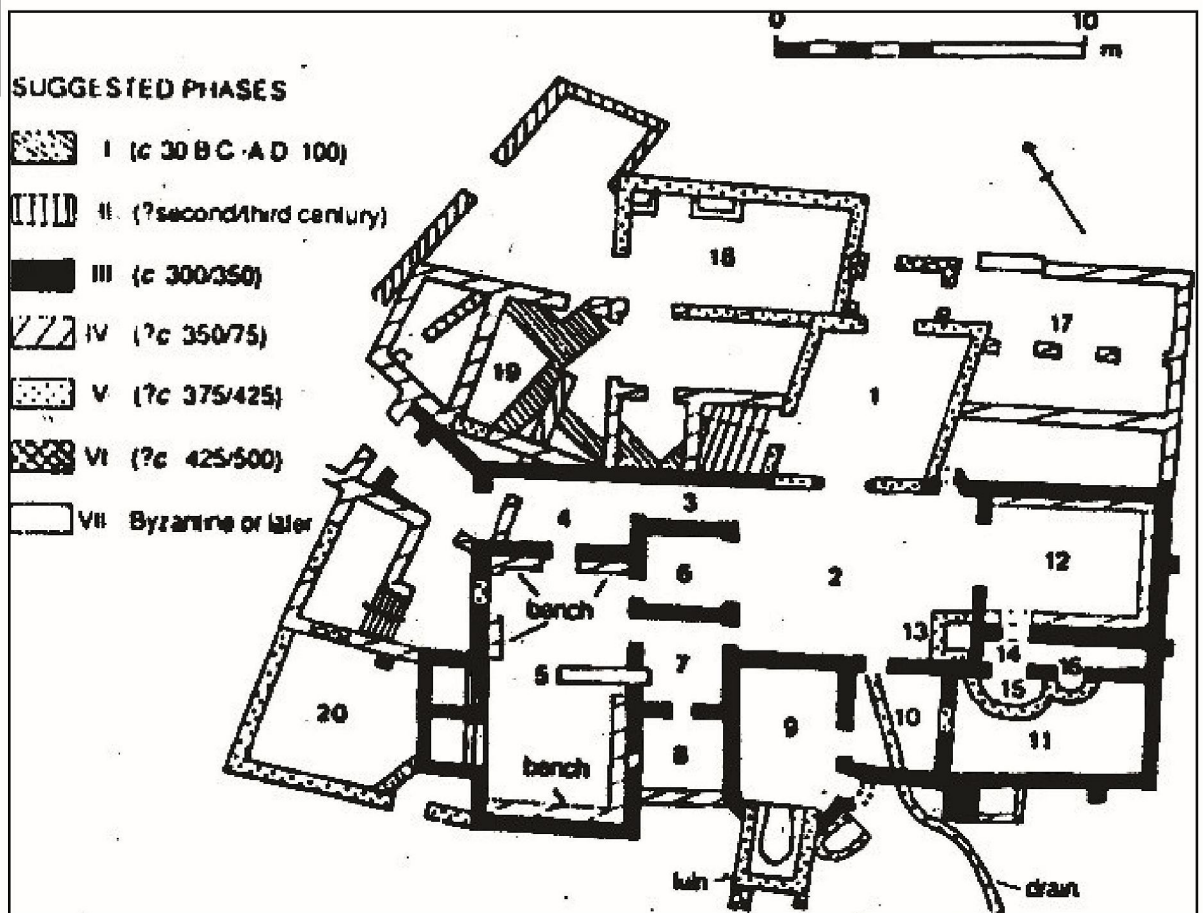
Schema planimetrico e cronologico delle terme di Sofiana (da WILSON 1990)
